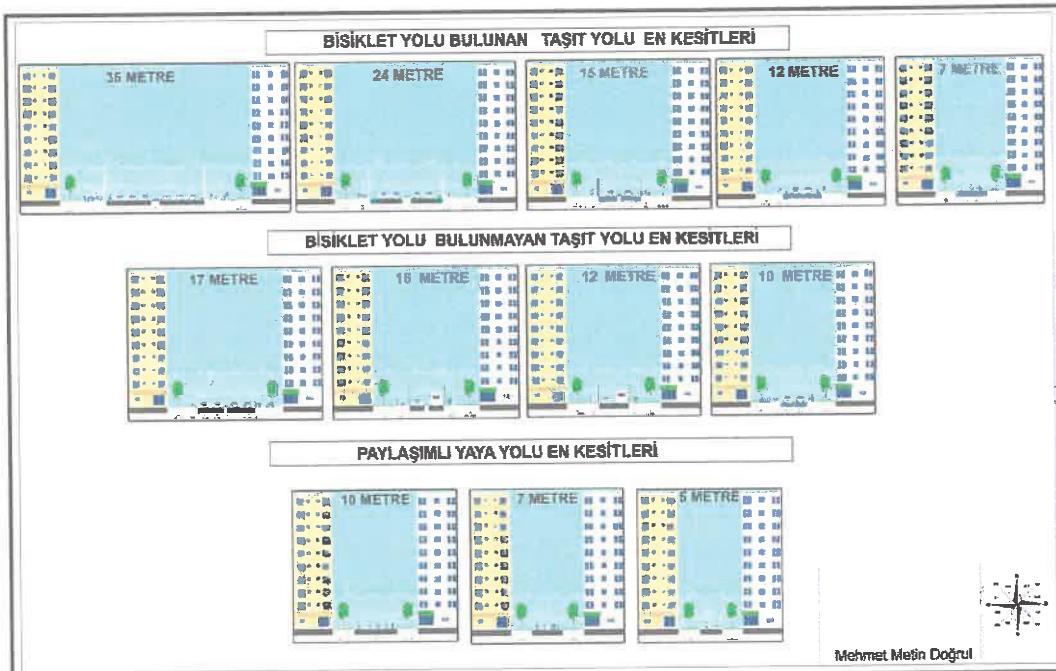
Revizyon Uygulama İmar Planı Ulaşım Şeması
